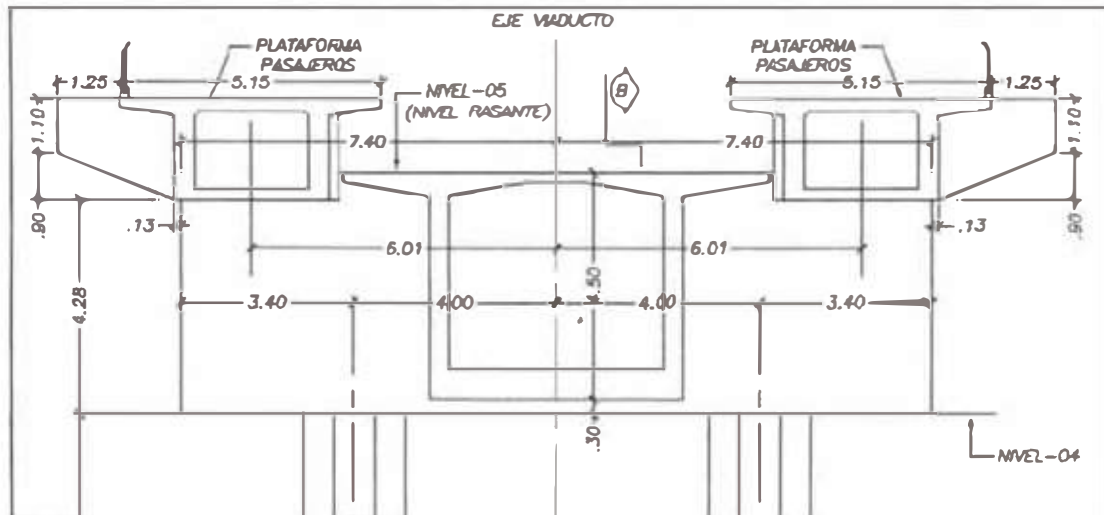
Sección Transversal Viga cabezal S50 y S51
